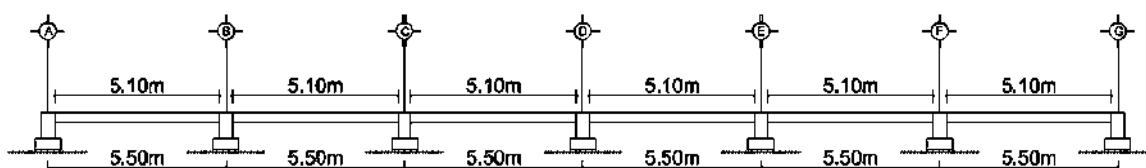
(a) Vista en alzado de la cimentación, eje longitudinal
